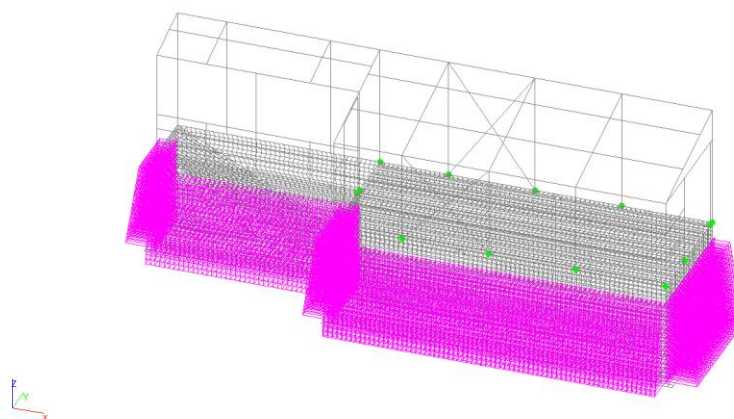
Расчетная модель монолитной лестницы по грунту, загруженная давлением от грунта (вариант №2)
